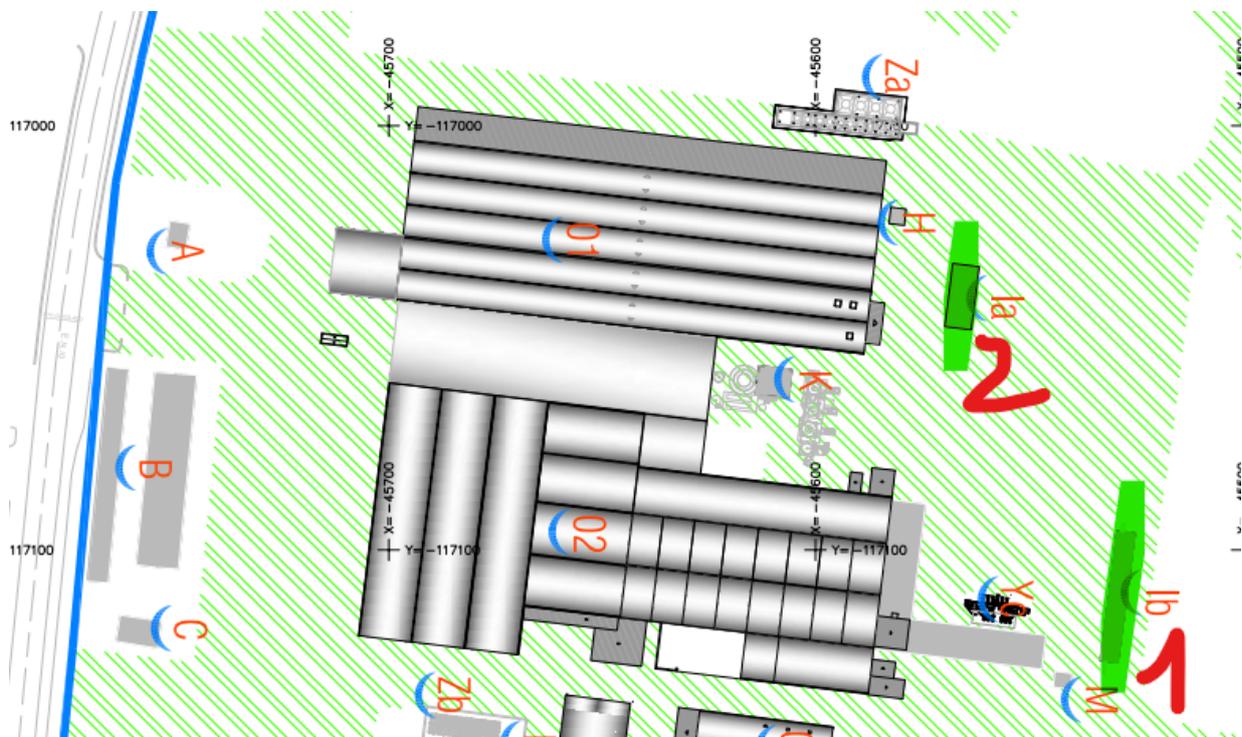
Extrato da planta Síntese do estabelecimento (ficheiro denominado de [2021-10-31\\_FIT\\_P\\_PlantaSintese.pdf](#))
